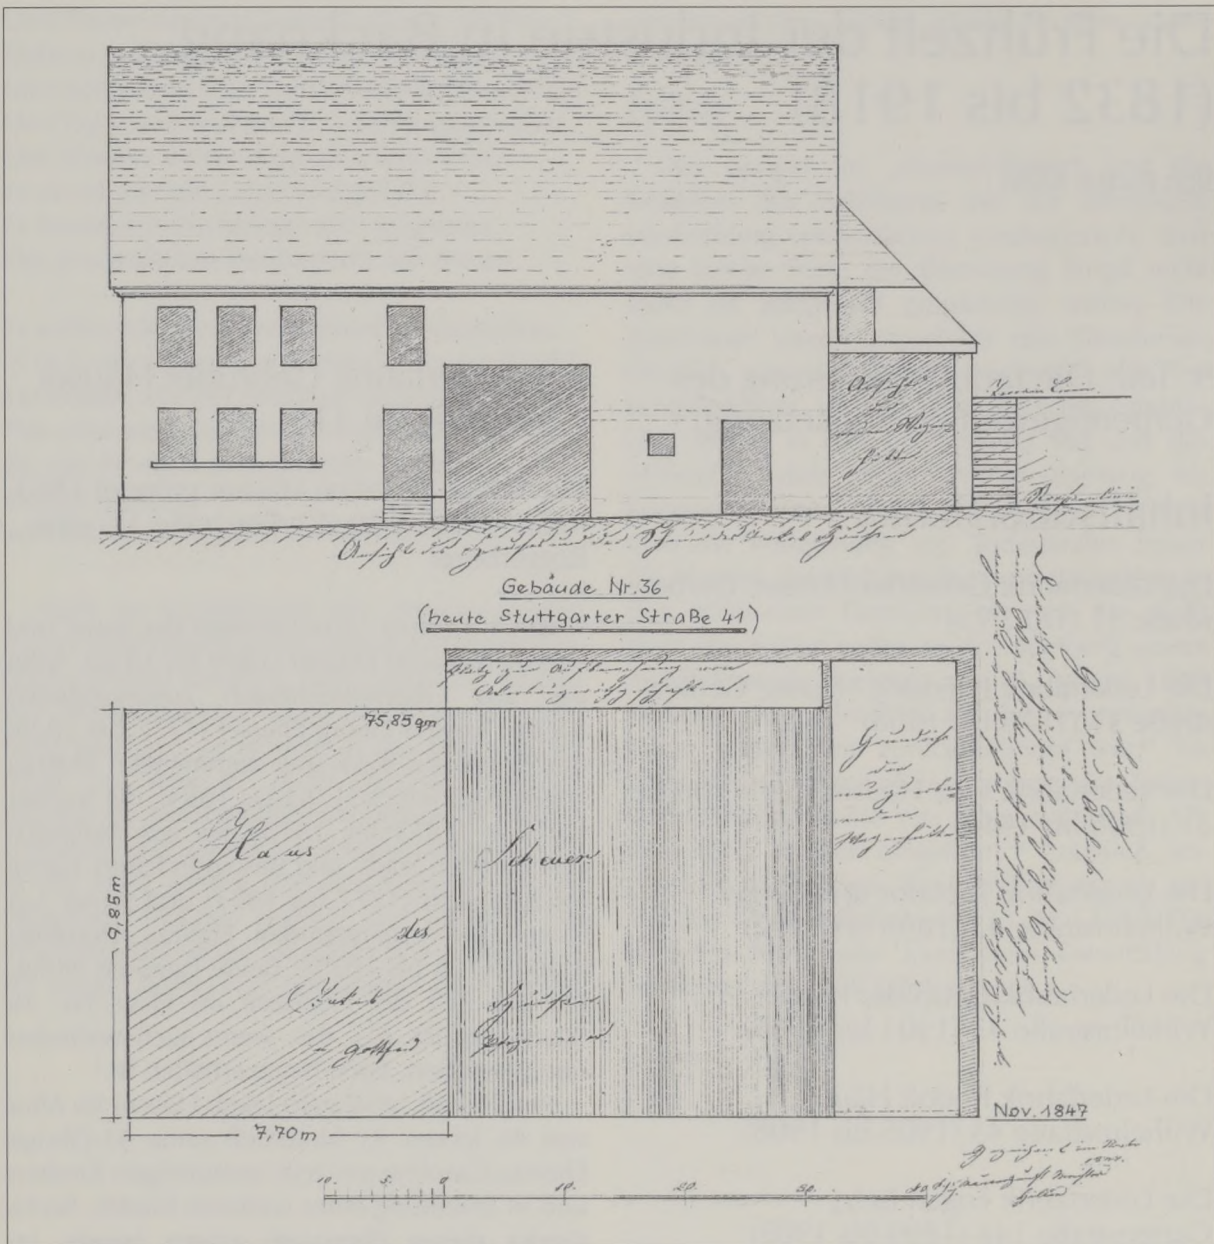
Grundriss und Ansicht des dem Bauern und Fuhrmann Jakob Häuser zur Hälfte gehörenden Anwesens Nr. 36 (Stuttgarter Straße 41). Abgebildet auf einem Baugesuch für die Erweiterung der Scheuer, vom November 1847.
